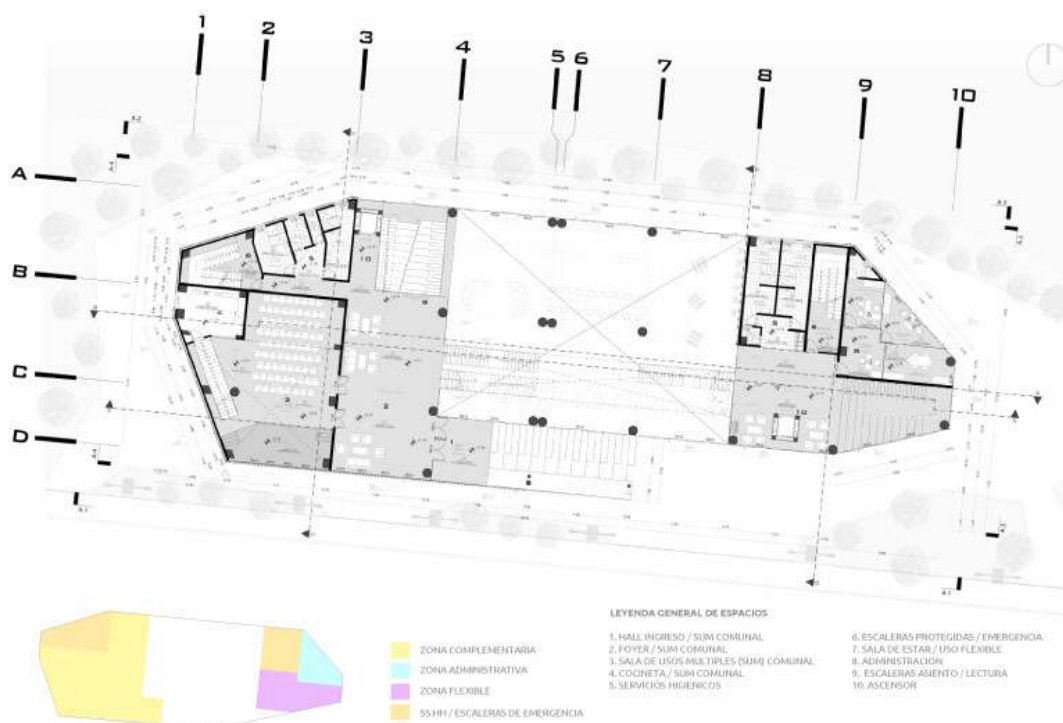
Plano de Segunda Planta del bloque de biblioteca
